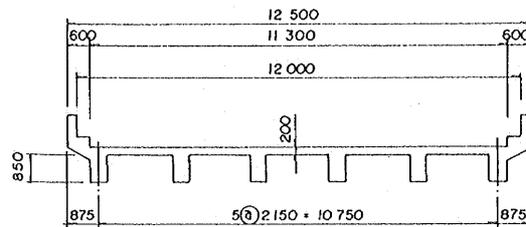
Puente sobre el Arroyo Tebicuary-mf (No.25, Puente Bailey)
